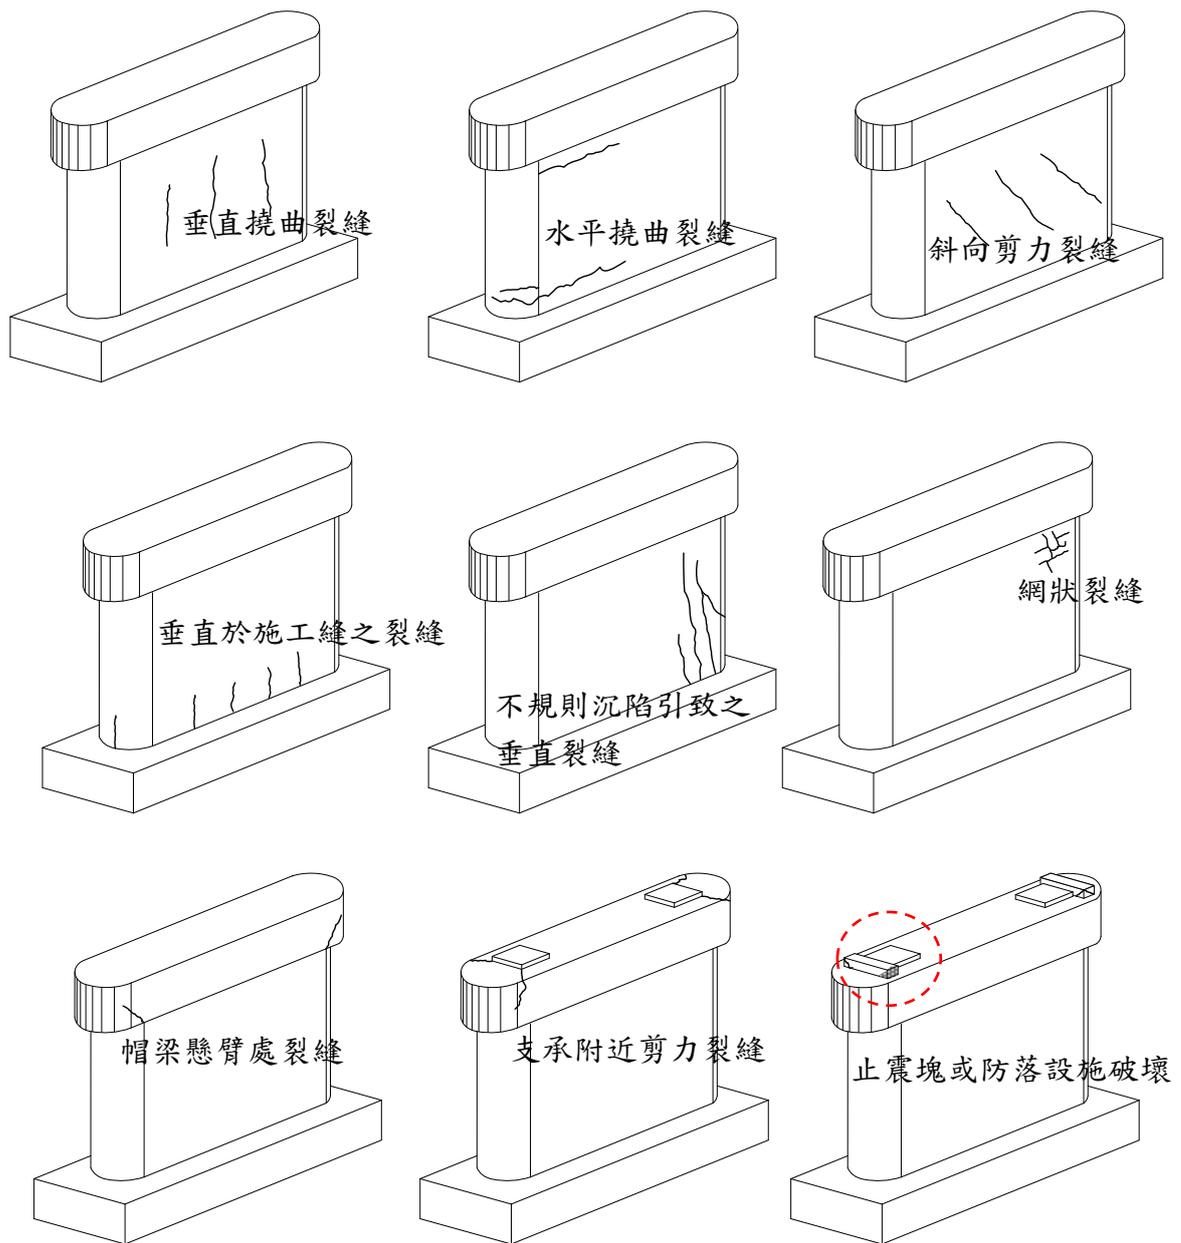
混凝土壁式橋墩裂縫示意圖
